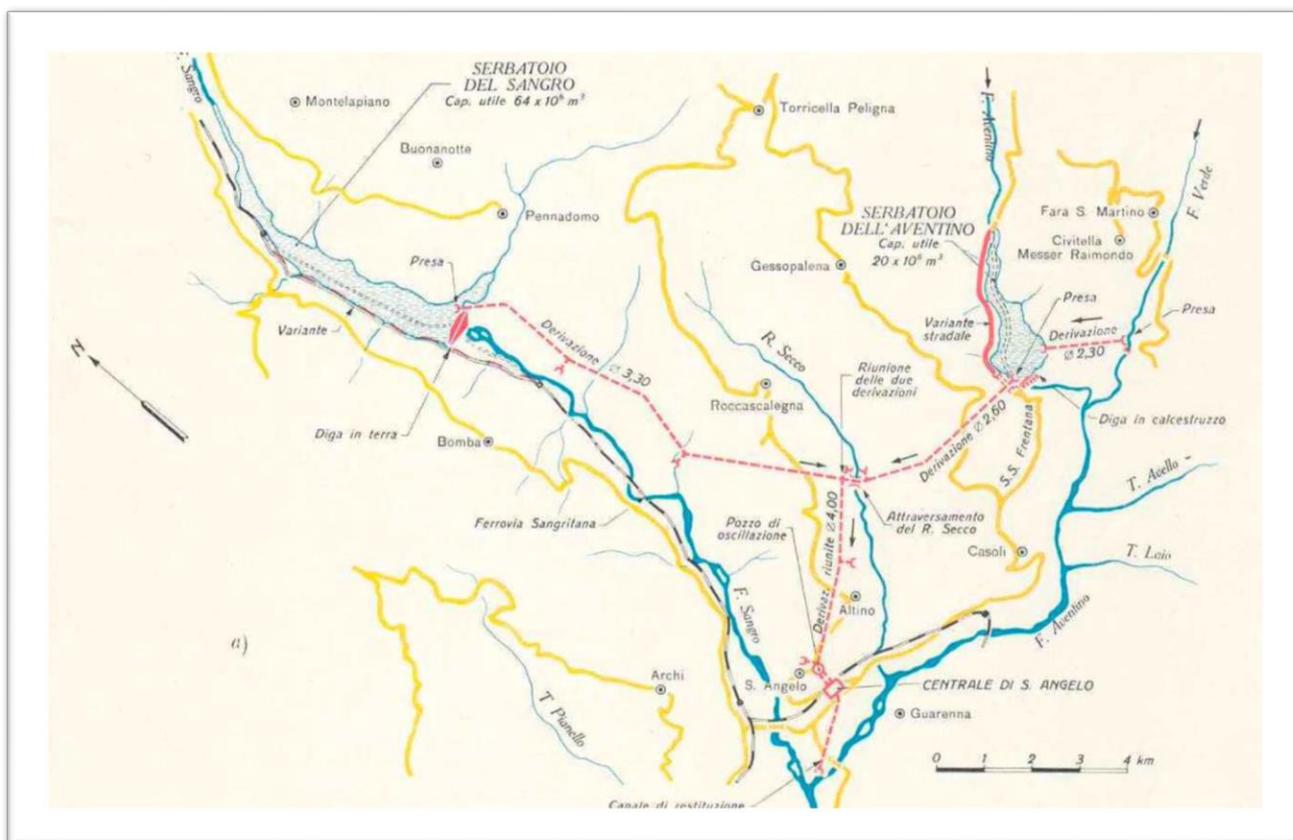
Dettaglio planimetrico dell'impianto idroelettrico "Sant'Angelo"
